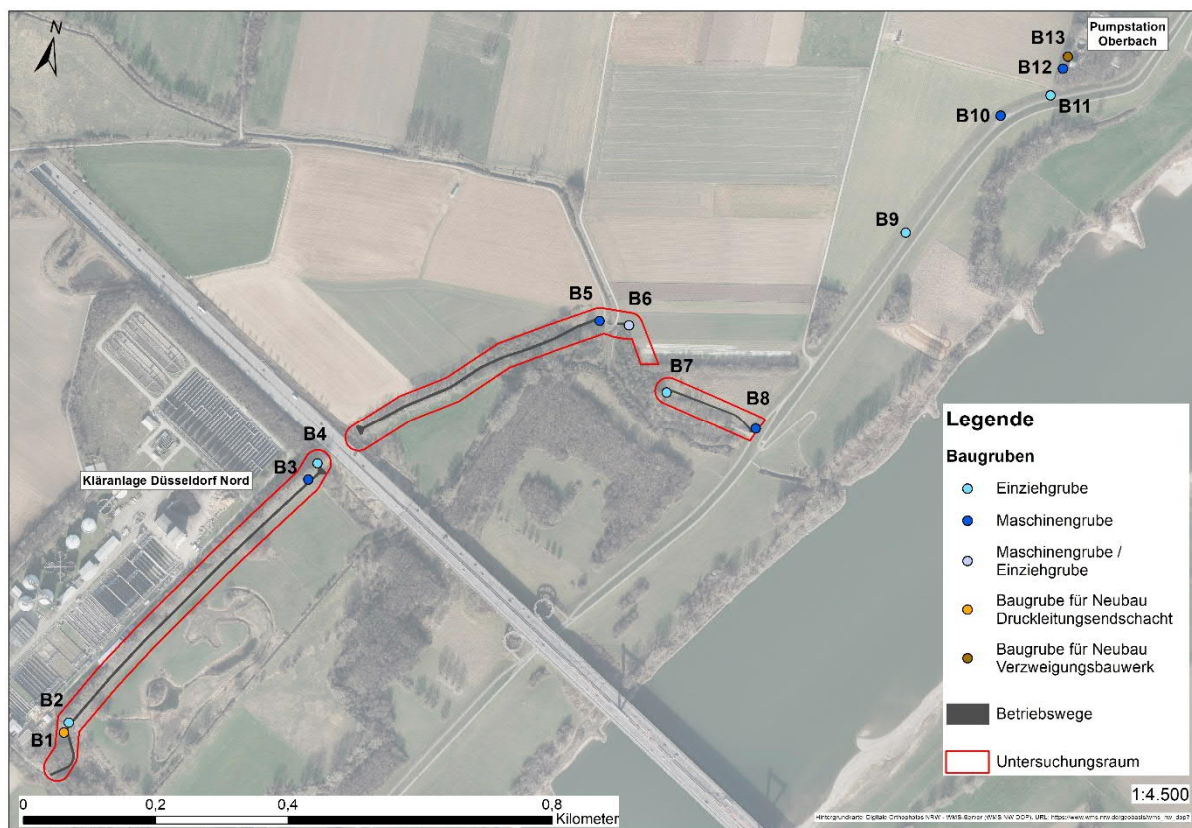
Lage und Funktion der 13 geplanten Baugruben (B)
